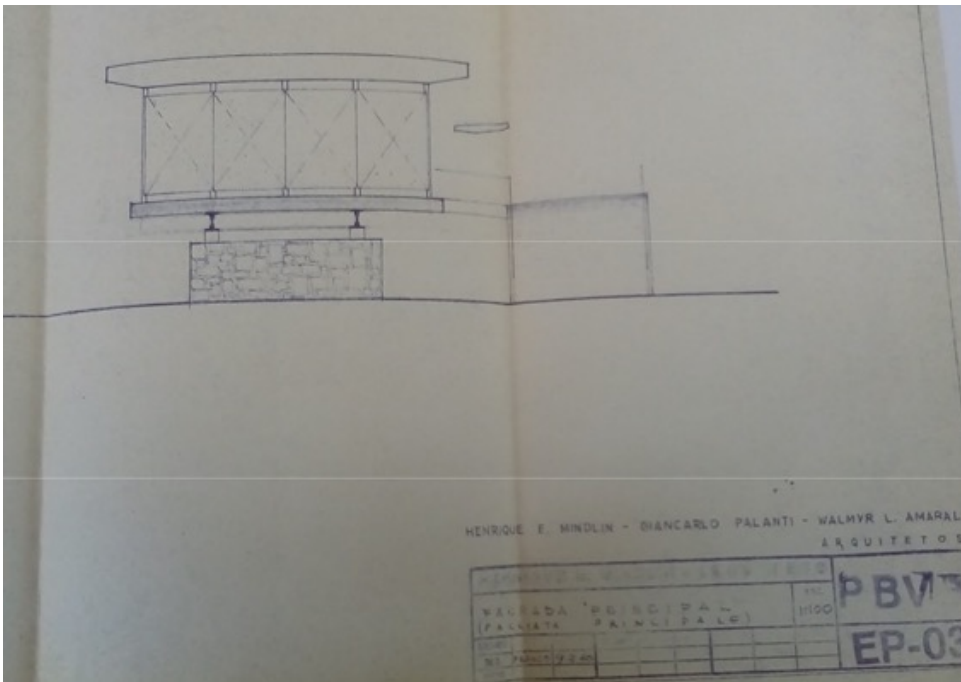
PROGETTO APPROVATO DALLA COMMISSIONE, 19 FEBBRAIO 1960.
